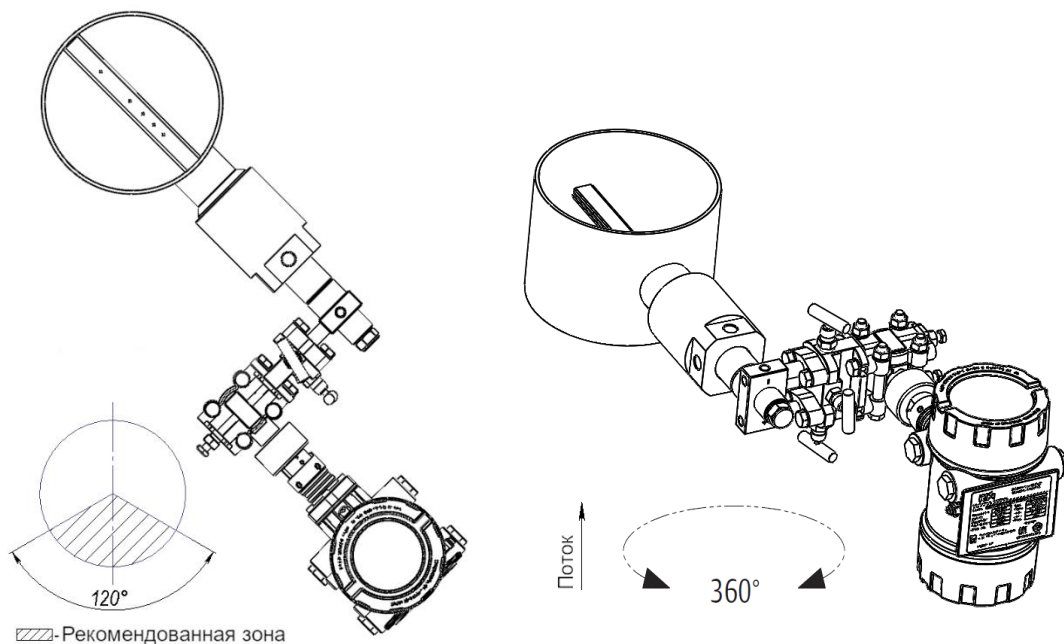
Расположение расходомера на трубопроводе выносной монтаж
